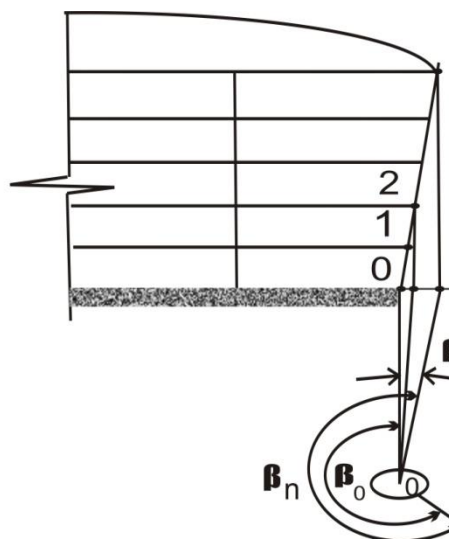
Схема измерения горизонтальных смещений образующей стенки резервуара
